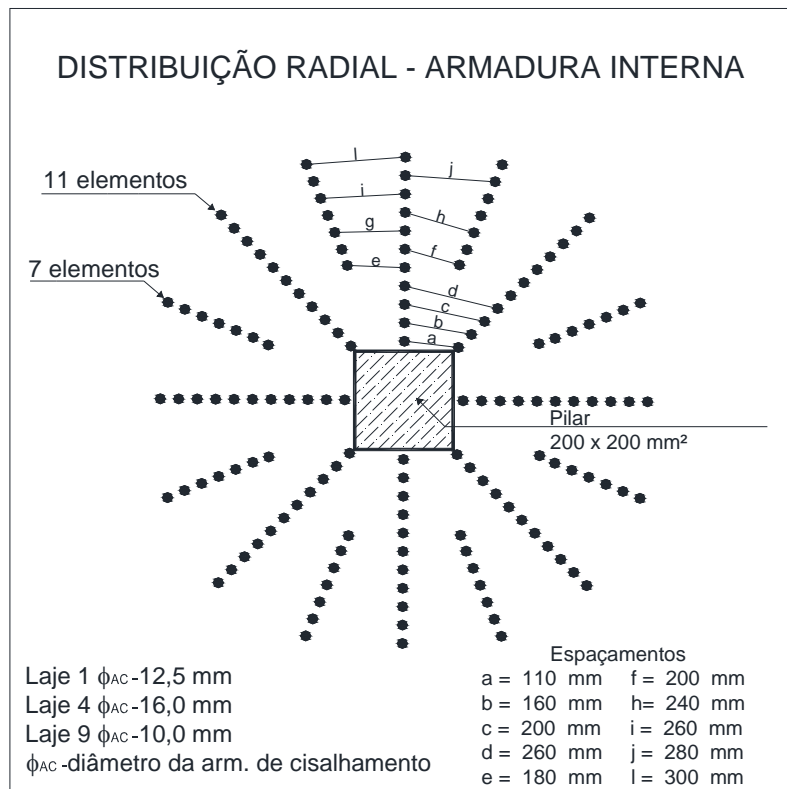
Esquema de distribuição radial da armadura de cisalhamento - lajes 1, 4 e 9.
